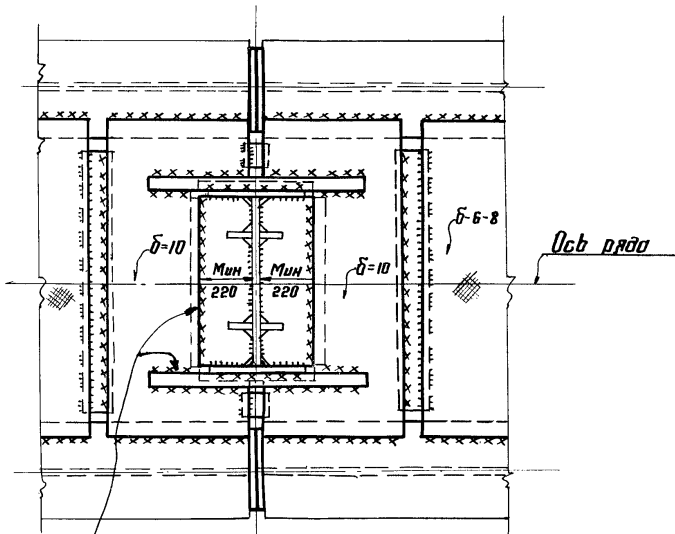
Крепление верхнего пояса неразрезных подкрановых балок и концевых разрезных подкрановых балок к колонне.
